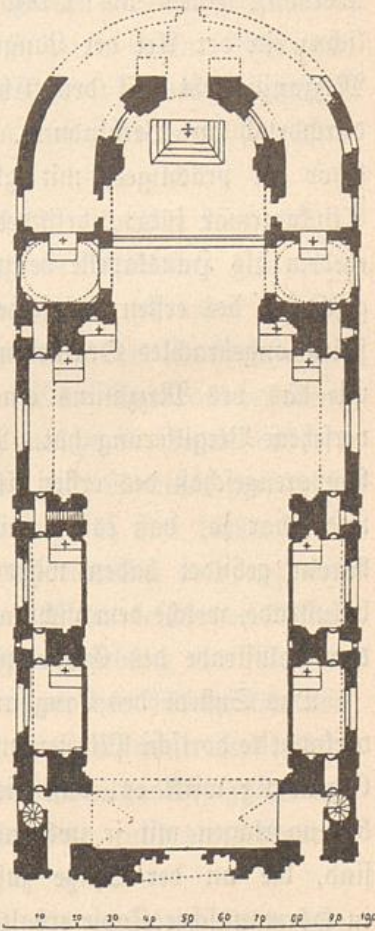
Bamberg. Martinskirche. Grundriß. (Nach Hörmanns Kopie des Originalgrundrisses.)
